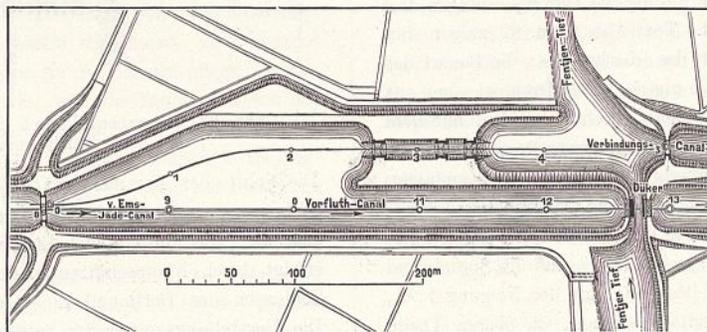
Lageplan der Schleuse zwischen Ems-Jade- und Verbindungscanal.
